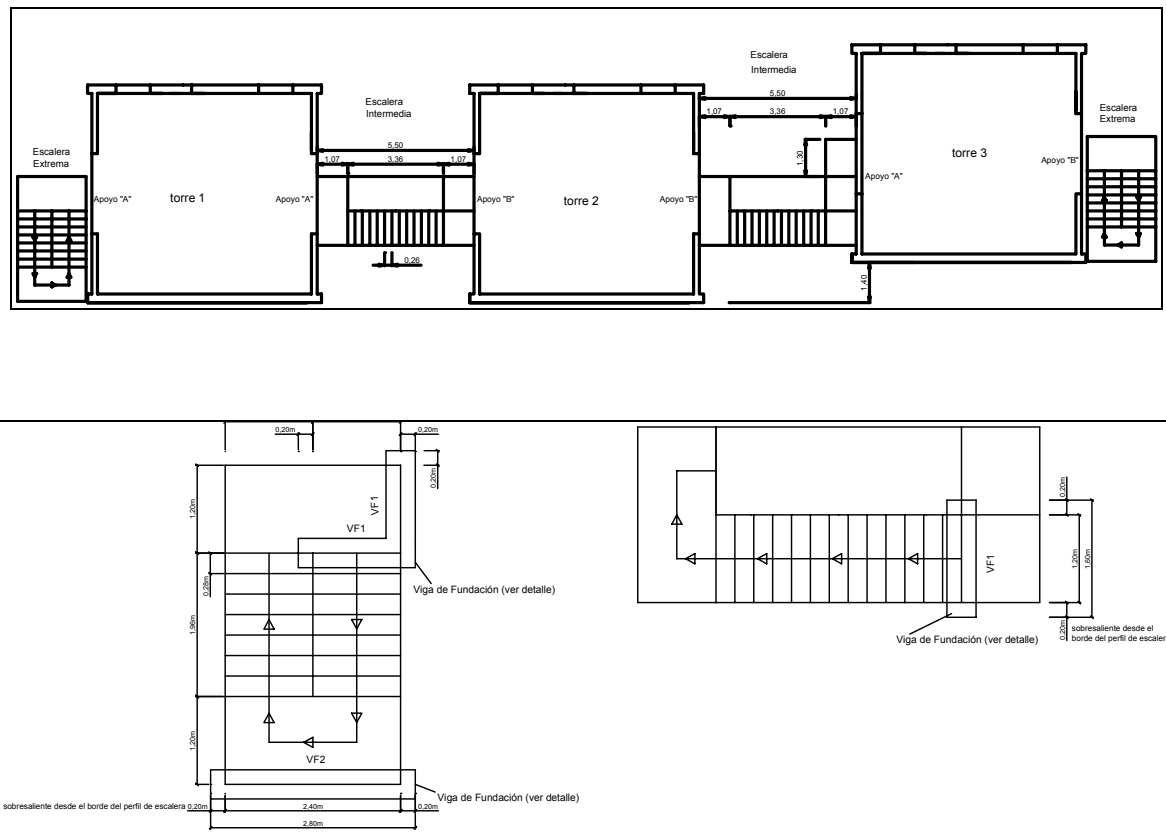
Disposición en planta del emplazamiento de las escaleras y sus dos tipologías. (Ver también Capítulo 9).
